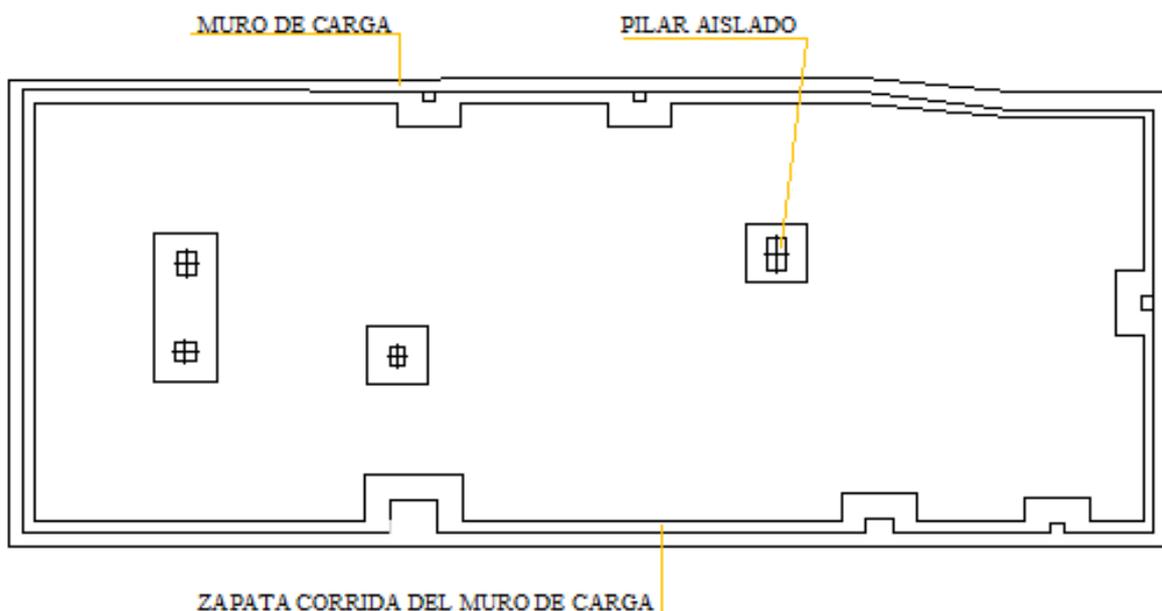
Esquema de cimentación. 2017. Fuente: propia
